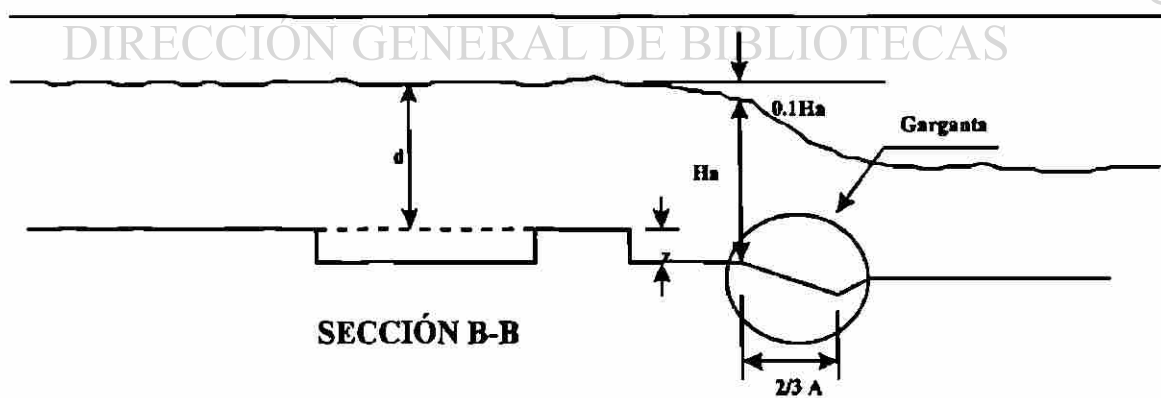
Sección longitudinal del Desarenador y del Canal Parshall, Sección B-B de Planta
